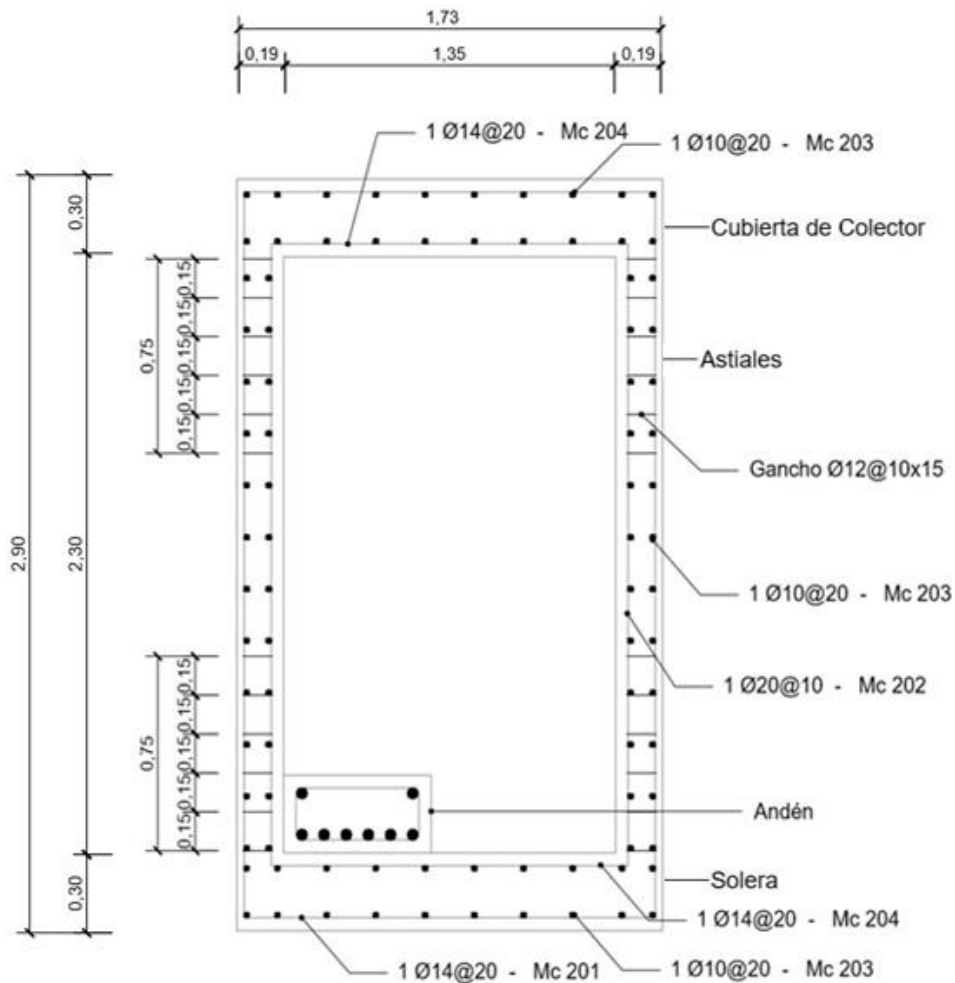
Armado acero de solera y astiales en sección de tramo 1-2-3
